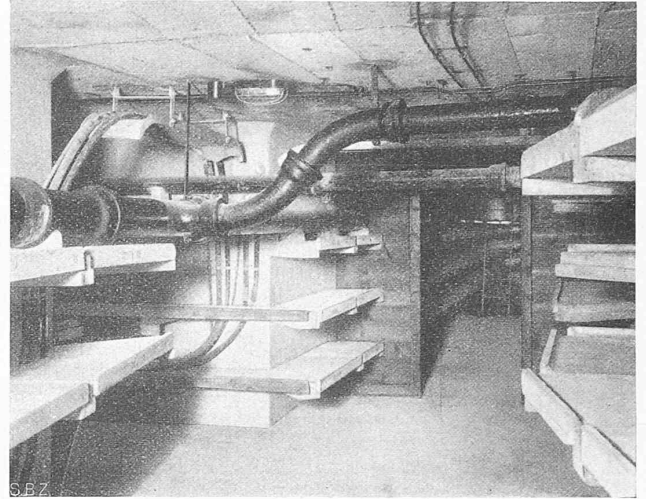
Schnittpunkt zweier Kanäle, mit Ventilationsstüre.
